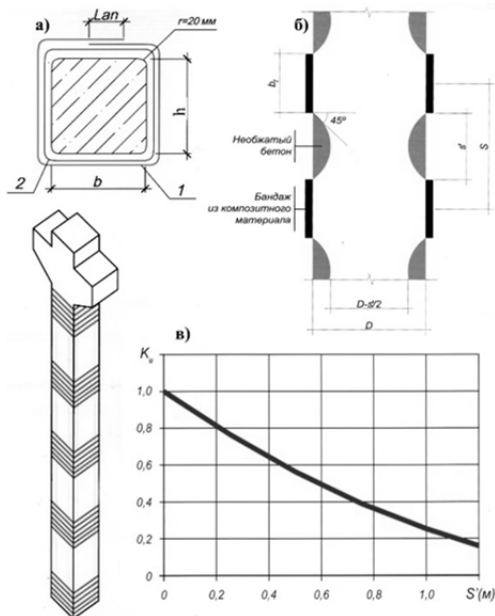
Усиление внецентренно сжатой железобетонной колонны
